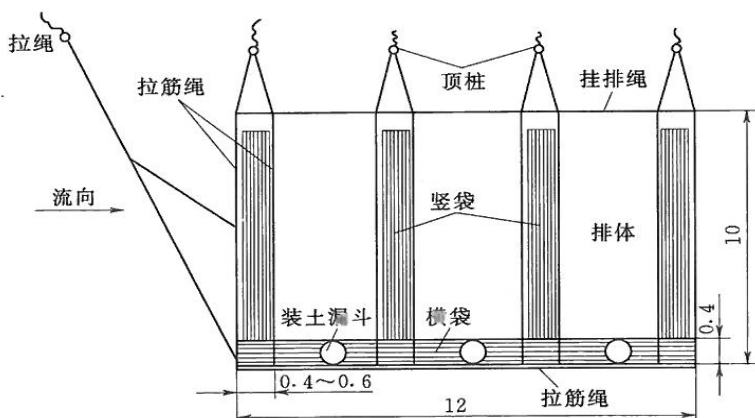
土工织物软体沉排立面示意图 (单位: m)
